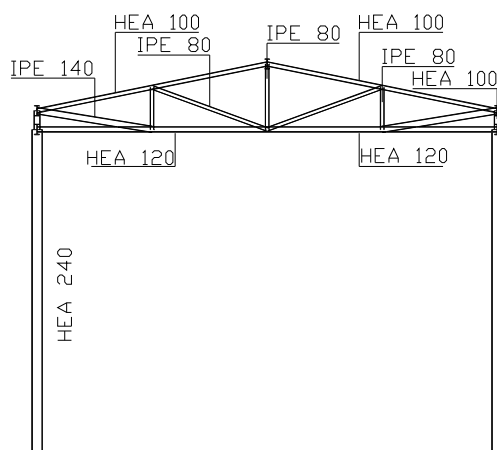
Pórtico com pilar de alma cheia, viga em treliça, vão de 10.00m, pilar em perfil com secção transversal HEA, viga em perfil com secção transversal HEA/IPE.
